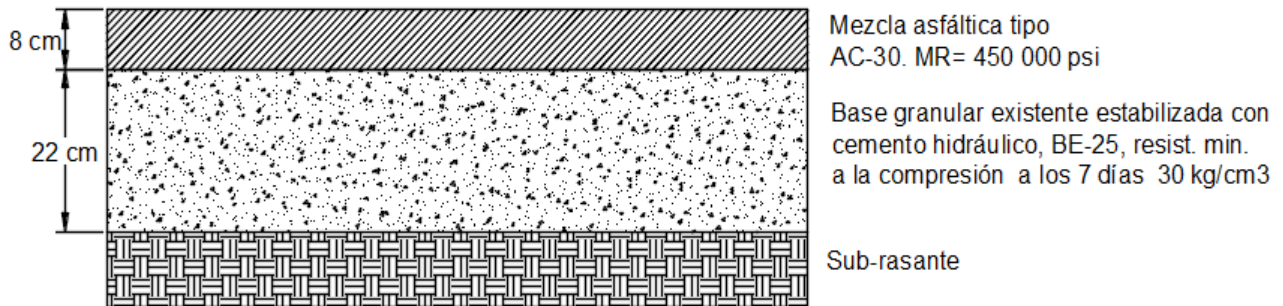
Perfil de la estructura de pavimento propuesta para el TH=39, P#1.
